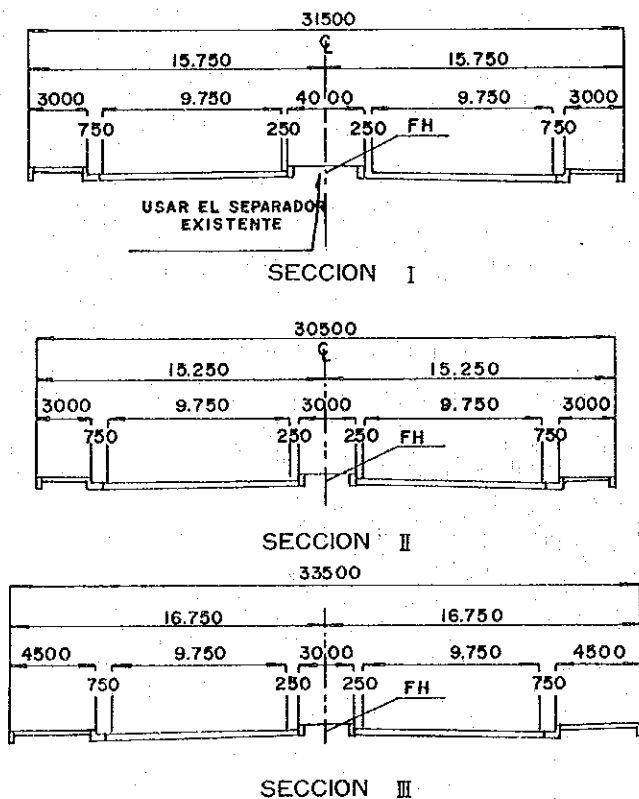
SECCION DE CONSTRUCCION DE LA CALLE 30
